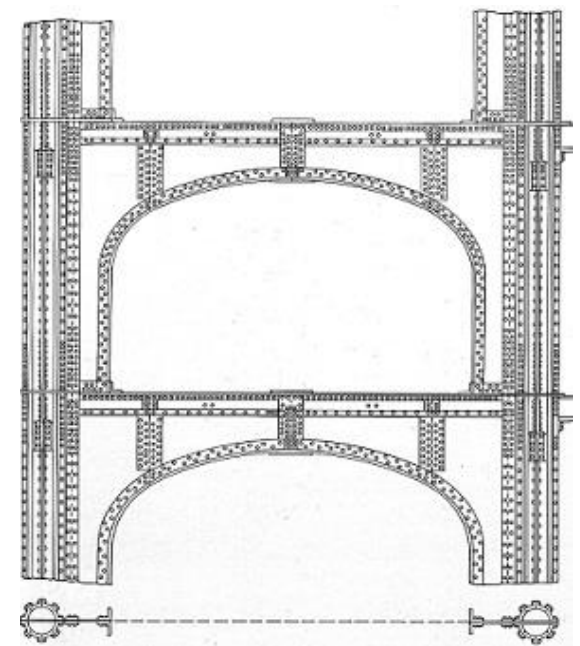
Sección del marco de acero del Old Colony Building, de Holabird y Roche, 1893-1894
